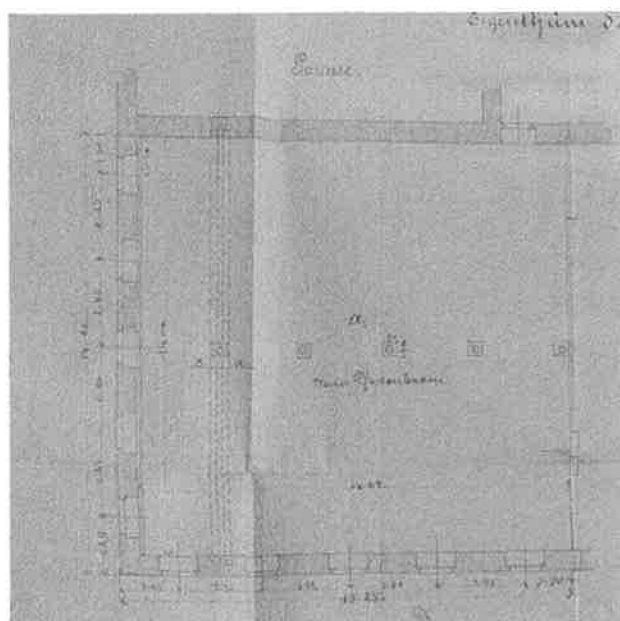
Grundriss Parterre/Schnitte (4)
